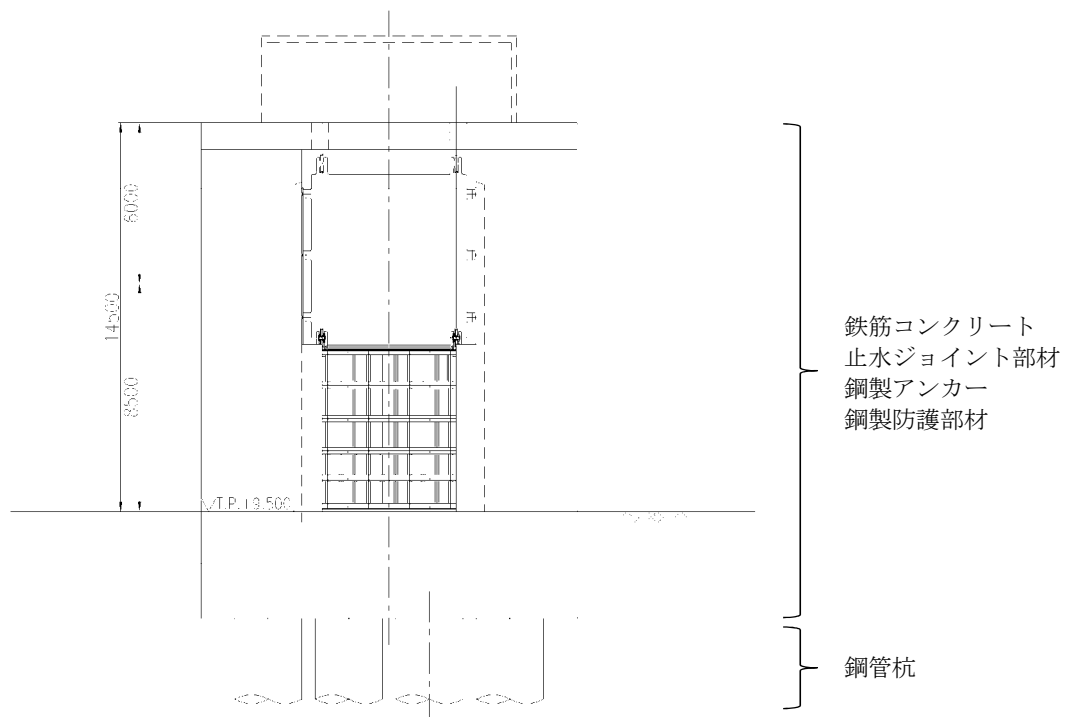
鉄筋コンクリート防潮壁正面図（防潮扉 2）
